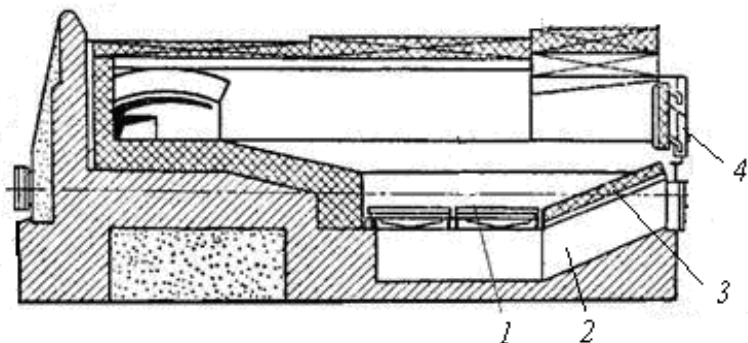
Схема типової топки на тверде паливо: 1 – колосникова решітка; 2 – піддувало; 3 – шуровочна плита; 4 – завантажувальні дверцята.
